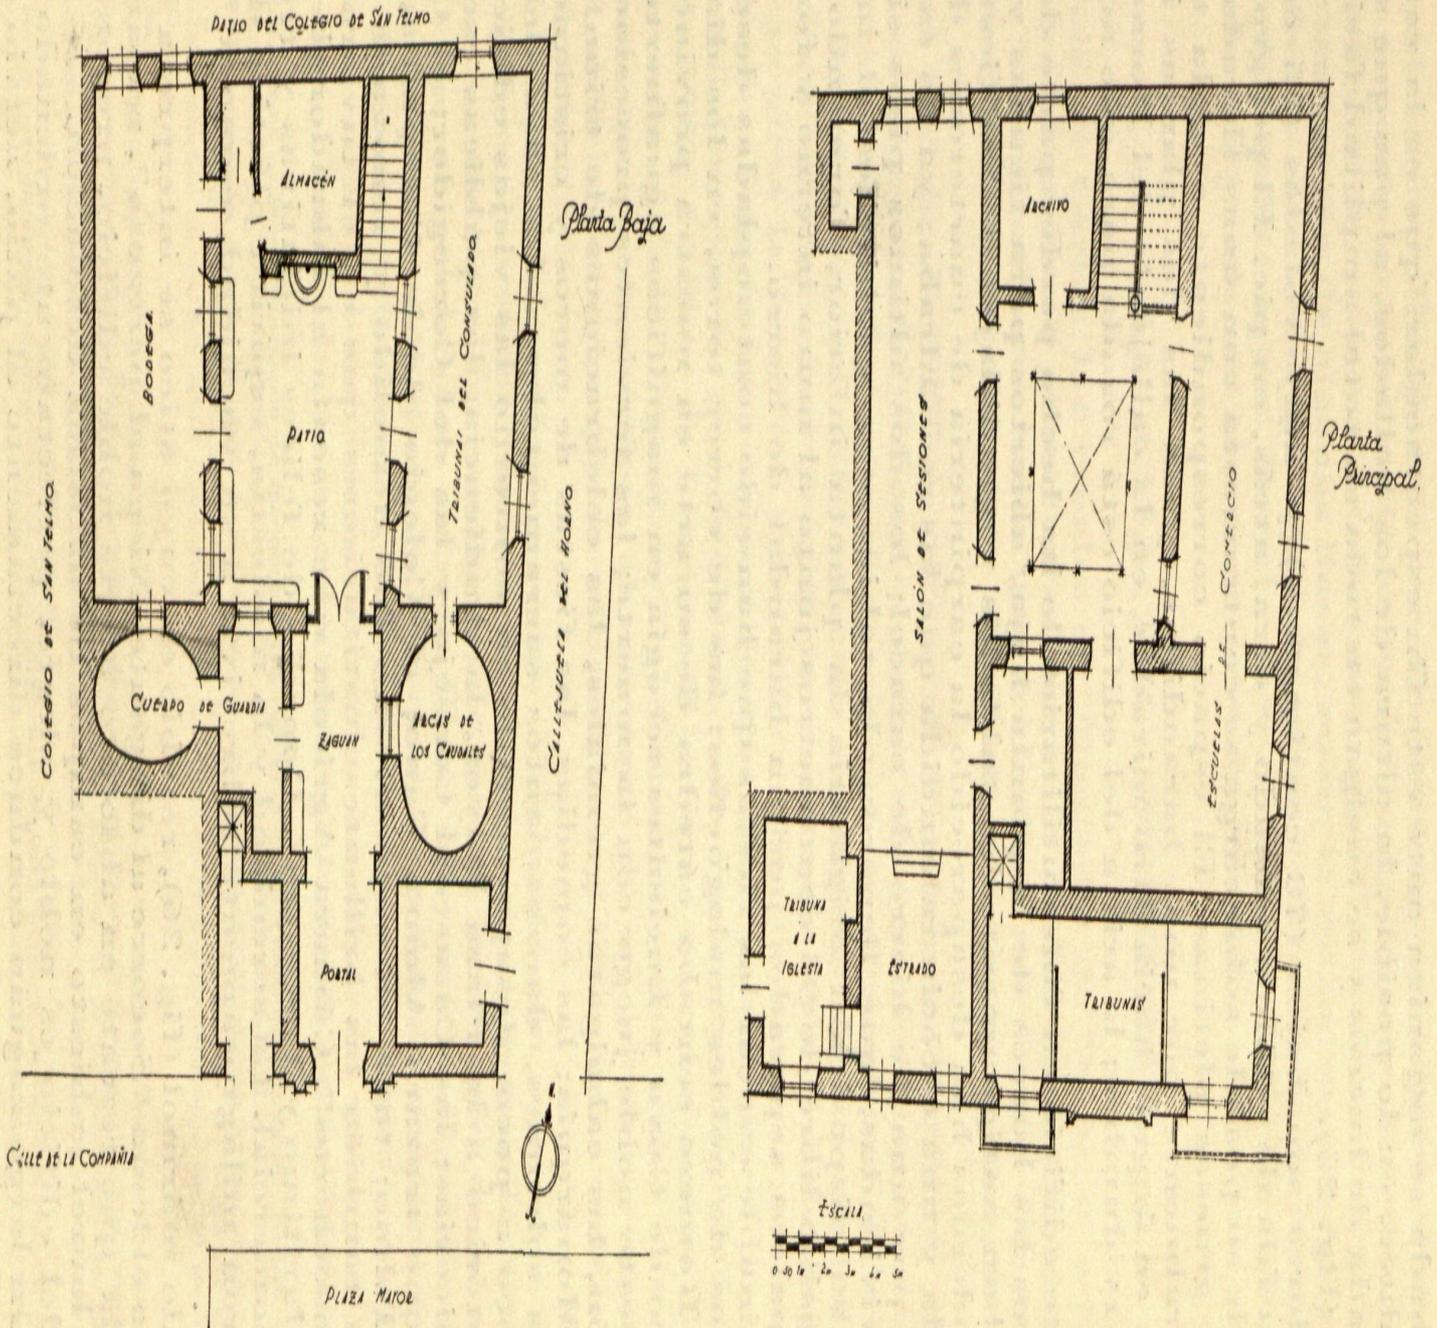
Málaga. Casa del Consulado Marítimo y Terrestre. Plantas baja y principal.
